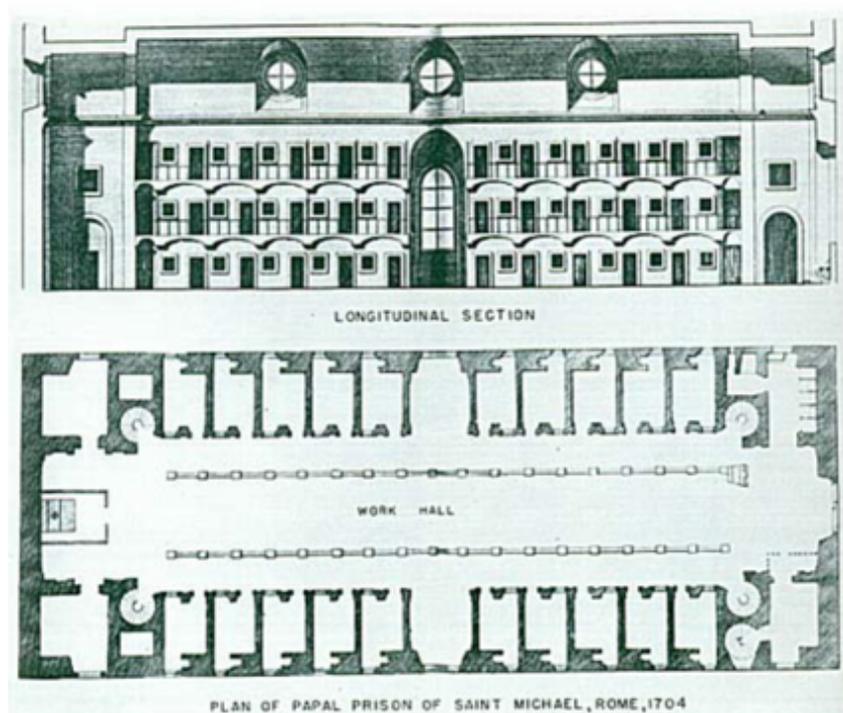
Prisão de San Michele. Planta e Alçado, Roma, 1704.
